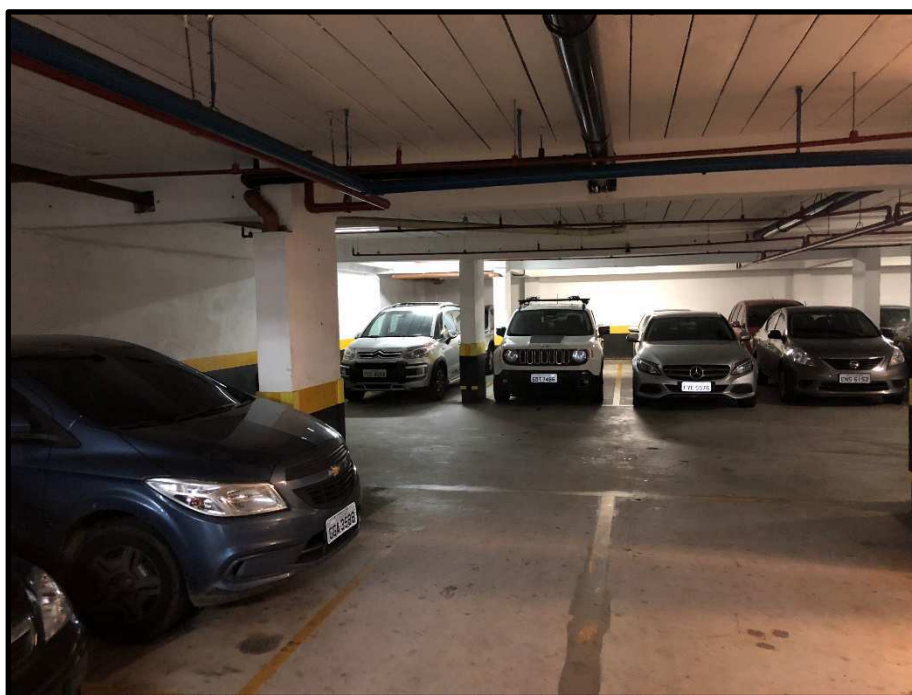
1º subsolo – vagas de garagem – Vista 2
